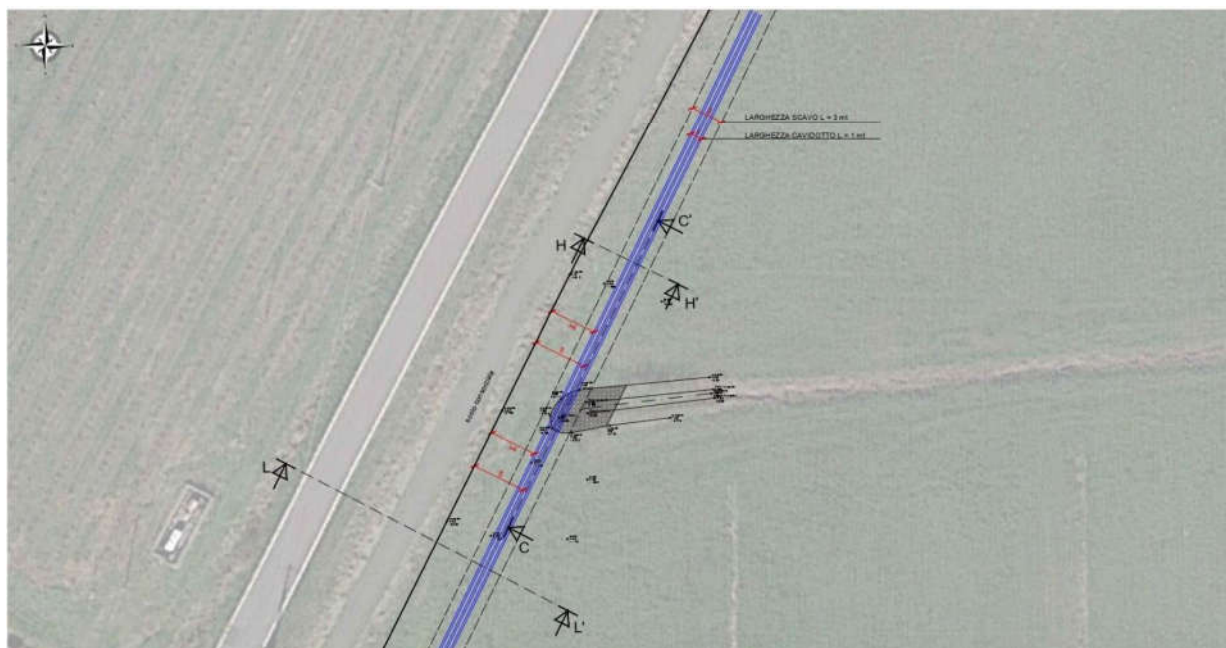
Tratto C-C' - Rilievo planoaltimetrico post-intervento
